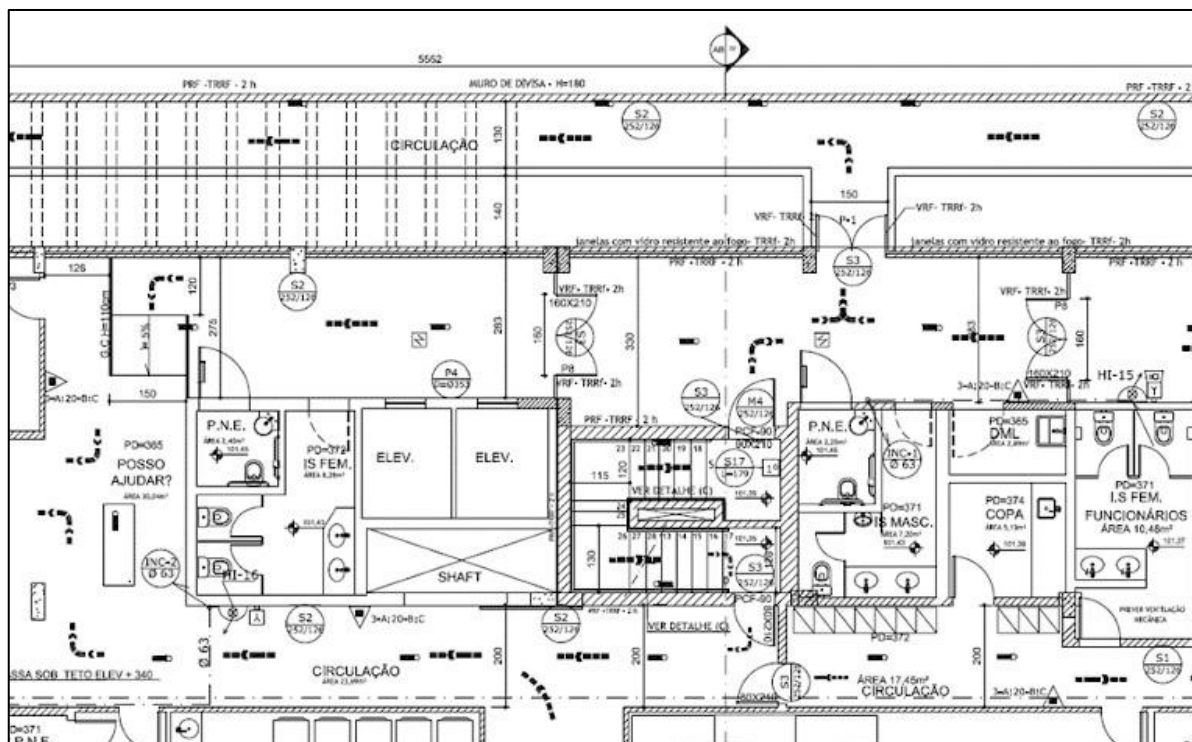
Planta 1º pavimento – soluções originais de combate a incêndio.
